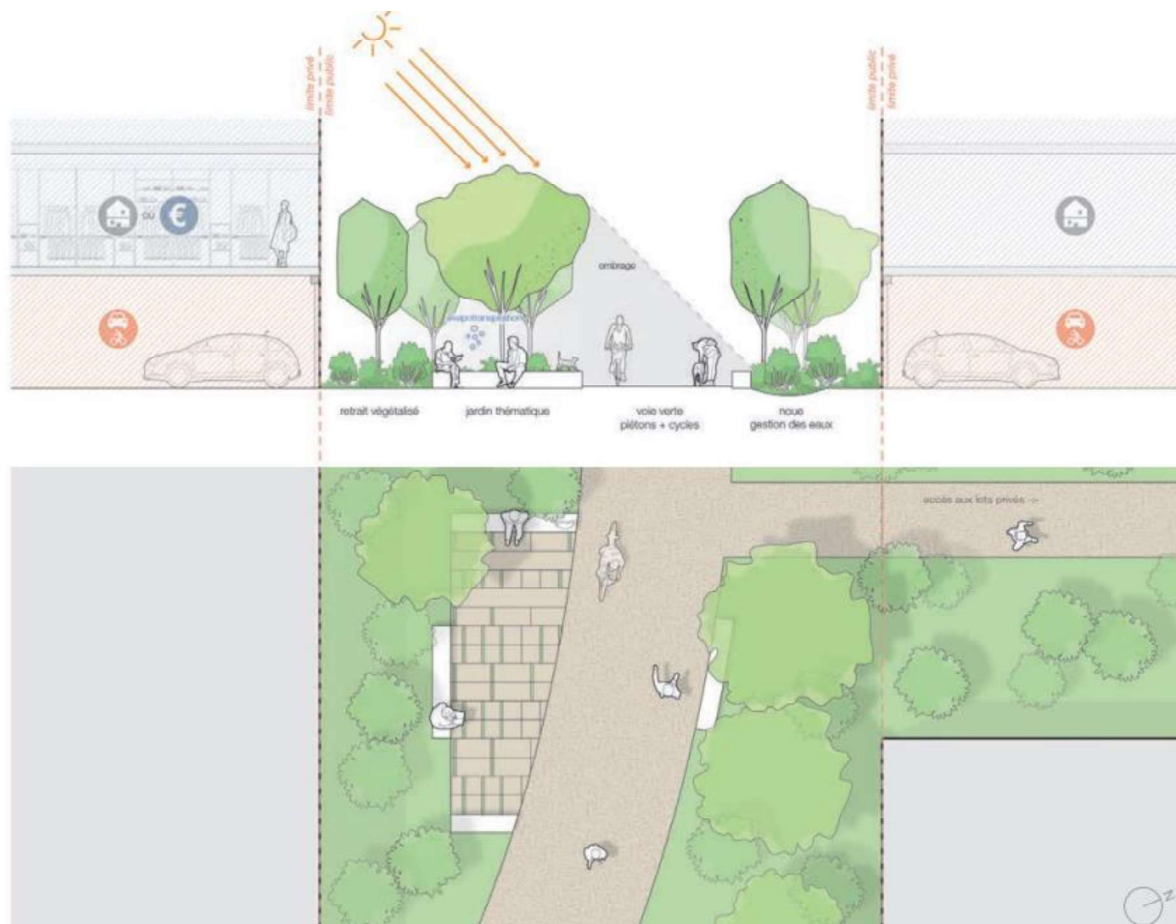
coupe de principe de la voie mode doux centrale (extrait du plan guide Gautier+Conquet\_aup, Ingerop, Aetc, L.E.A)
